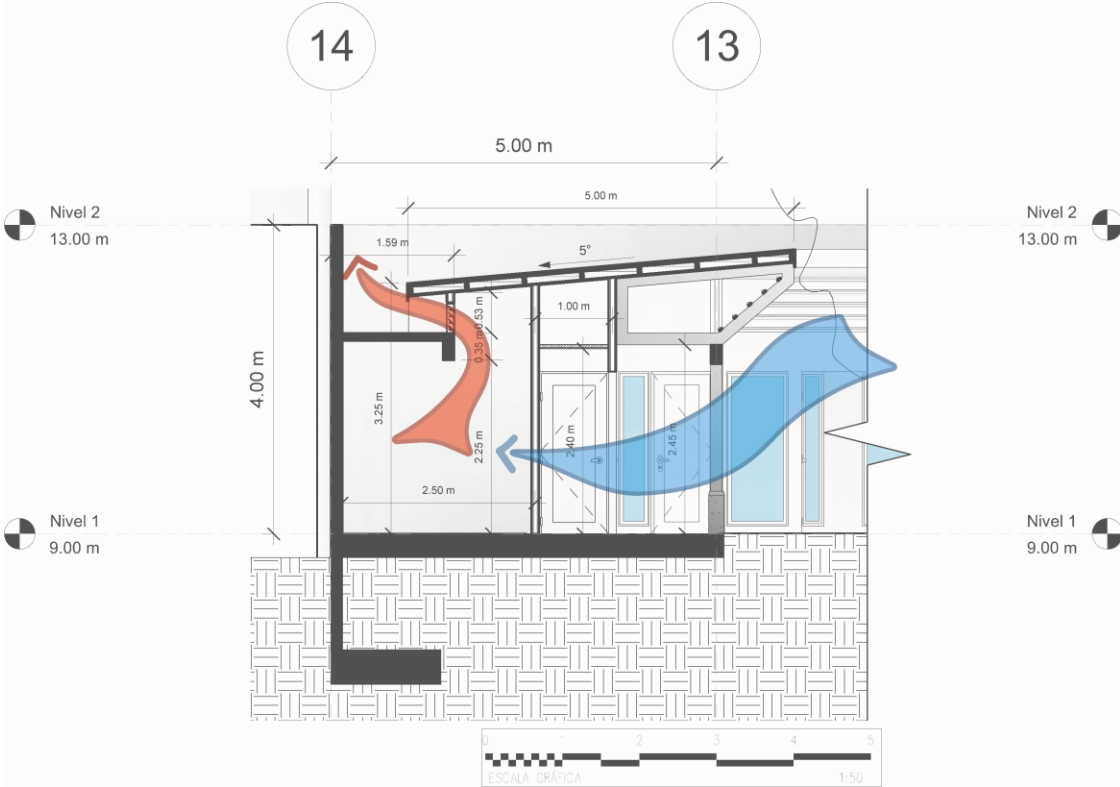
Ampliación Sección longitudinal A – A con ventilación
